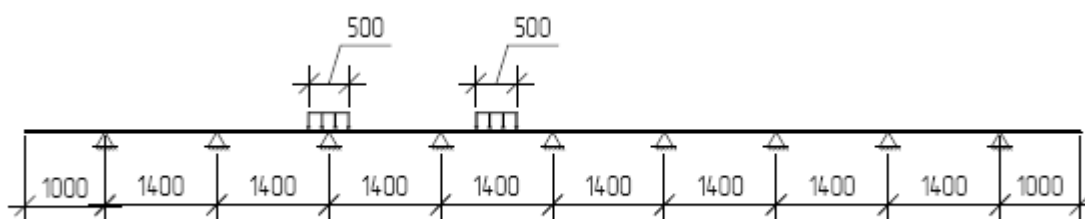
Розрахункова схема (нерозрізна балка) залізобетонної плити прогонової будови
